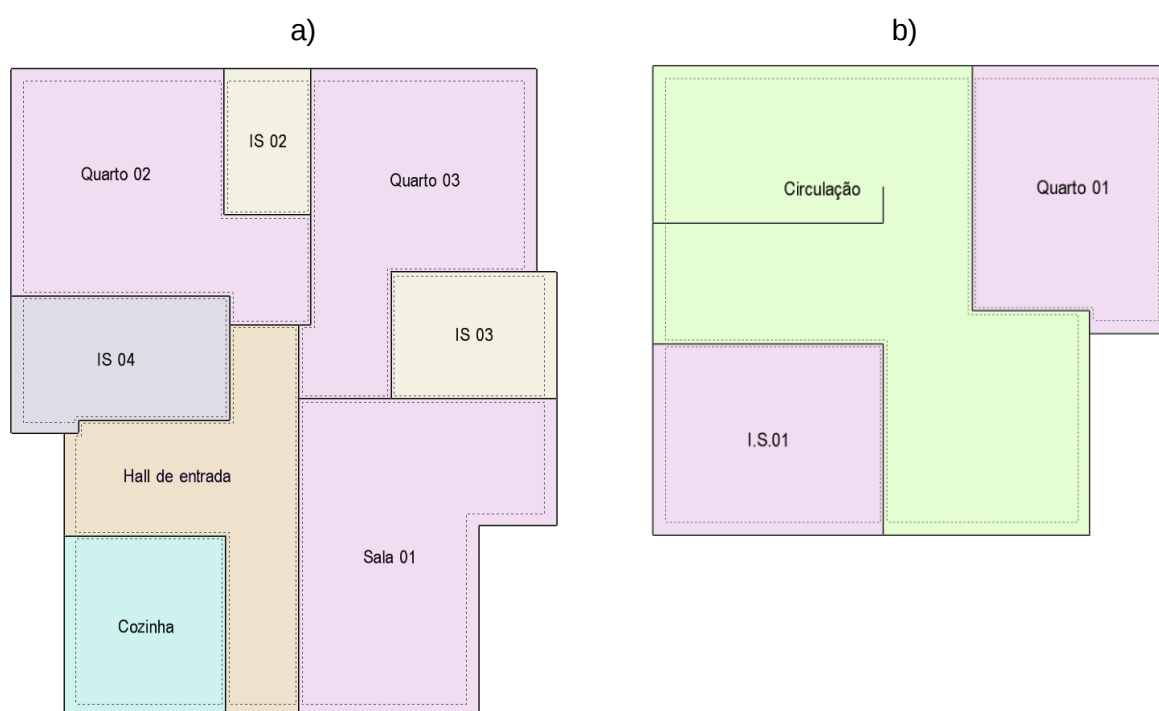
Planta da habitação. a) piso 0; b) piso 1.
